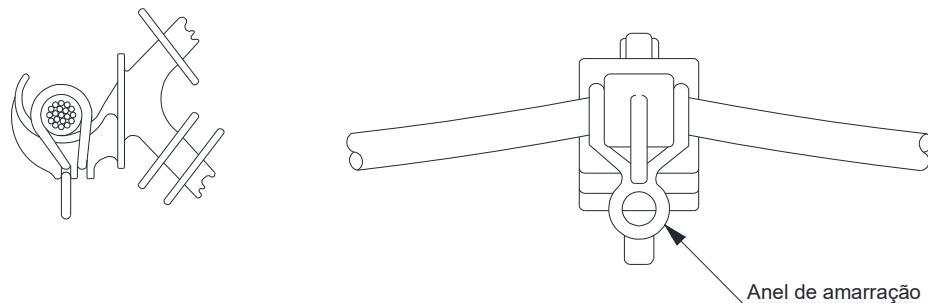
Amarrações e ligações – Amarração do cabo protegido em espaçador monofásico, vertical e losangular – Anel de AmarrAÇÃO
